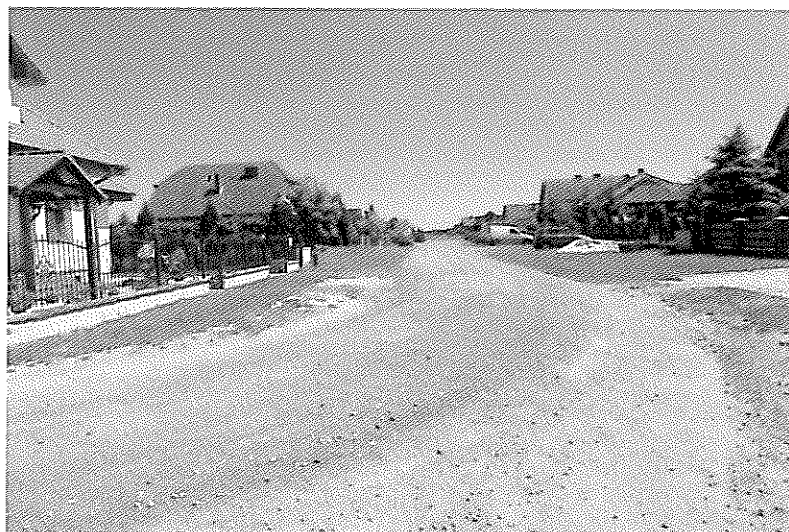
Widok ul. Bażantowej – od strony ul. Sokolej
